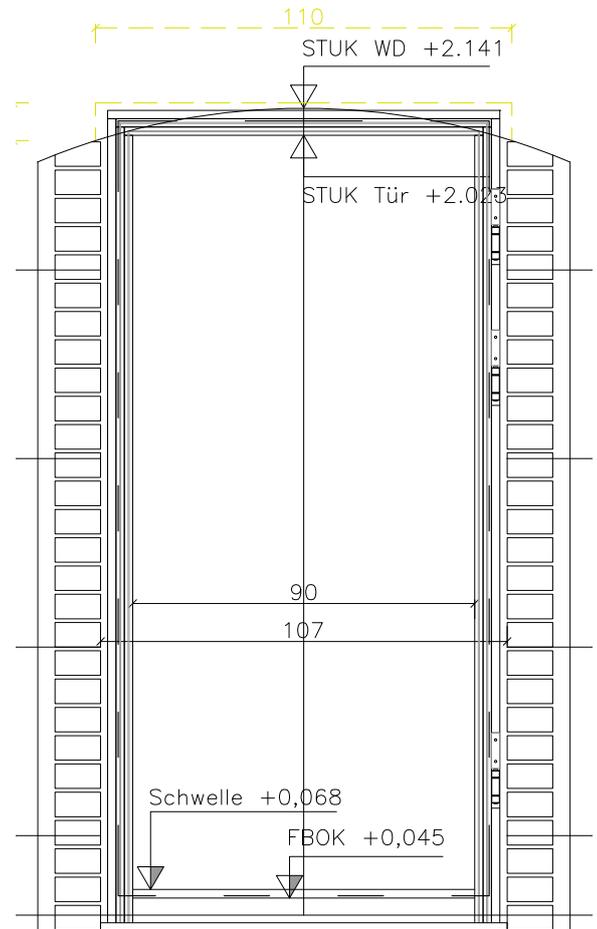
Einbaudetail Tür 2, Ansicht, M = 1:20
